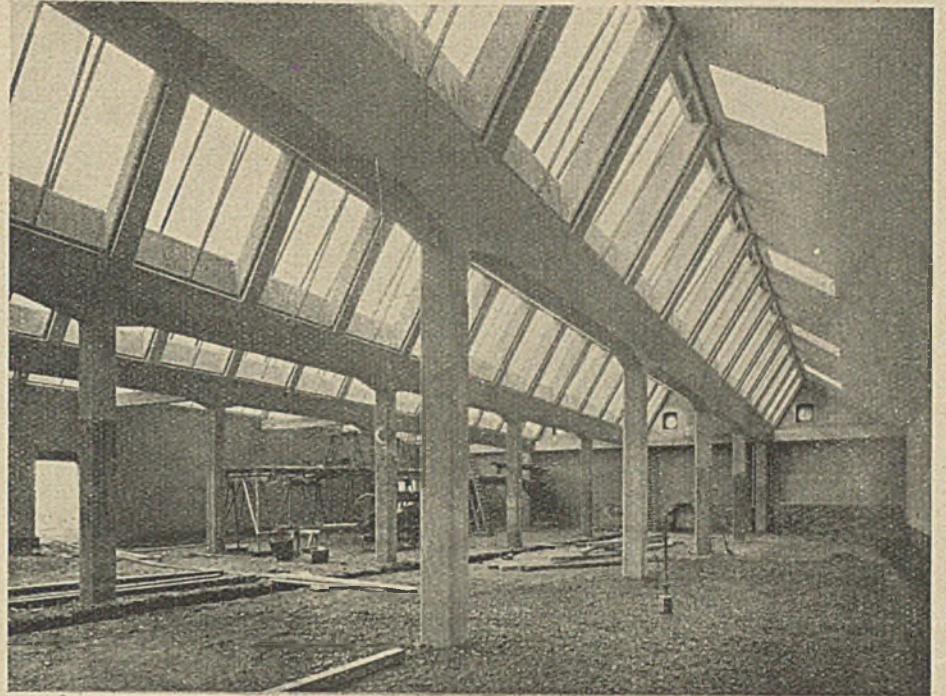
d. Innenansicht des Shedbaues der Färberei- und Appreturanstalt F. B. Reichel, Nachf., Gröna i. Sa.
